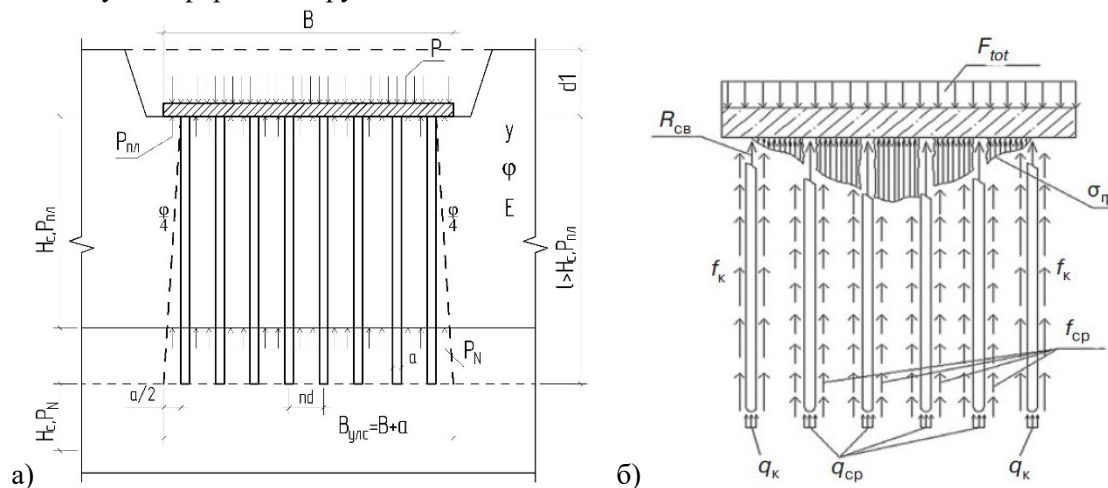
Расчетные схемы: а) Расчетная схема взаимодействия плитно-свайного крупноразмерного фундамента с грунтовым массивом [13]; б) Расчетная схема плитно-свайного фундамента [14];
